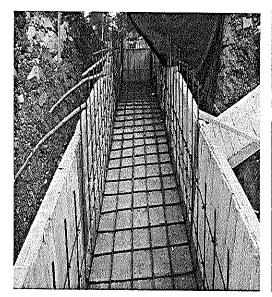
y 45. Construcción de Estructuras en concreto para paso y salida
